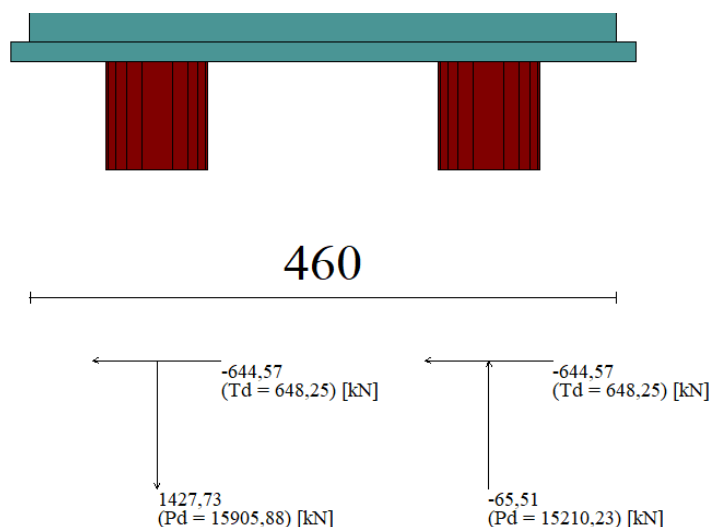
Sollecitazioni massime a testa palo dei MURI DI CONTRORIPA - FONDAZIONE SU PALI - TIPO 4
